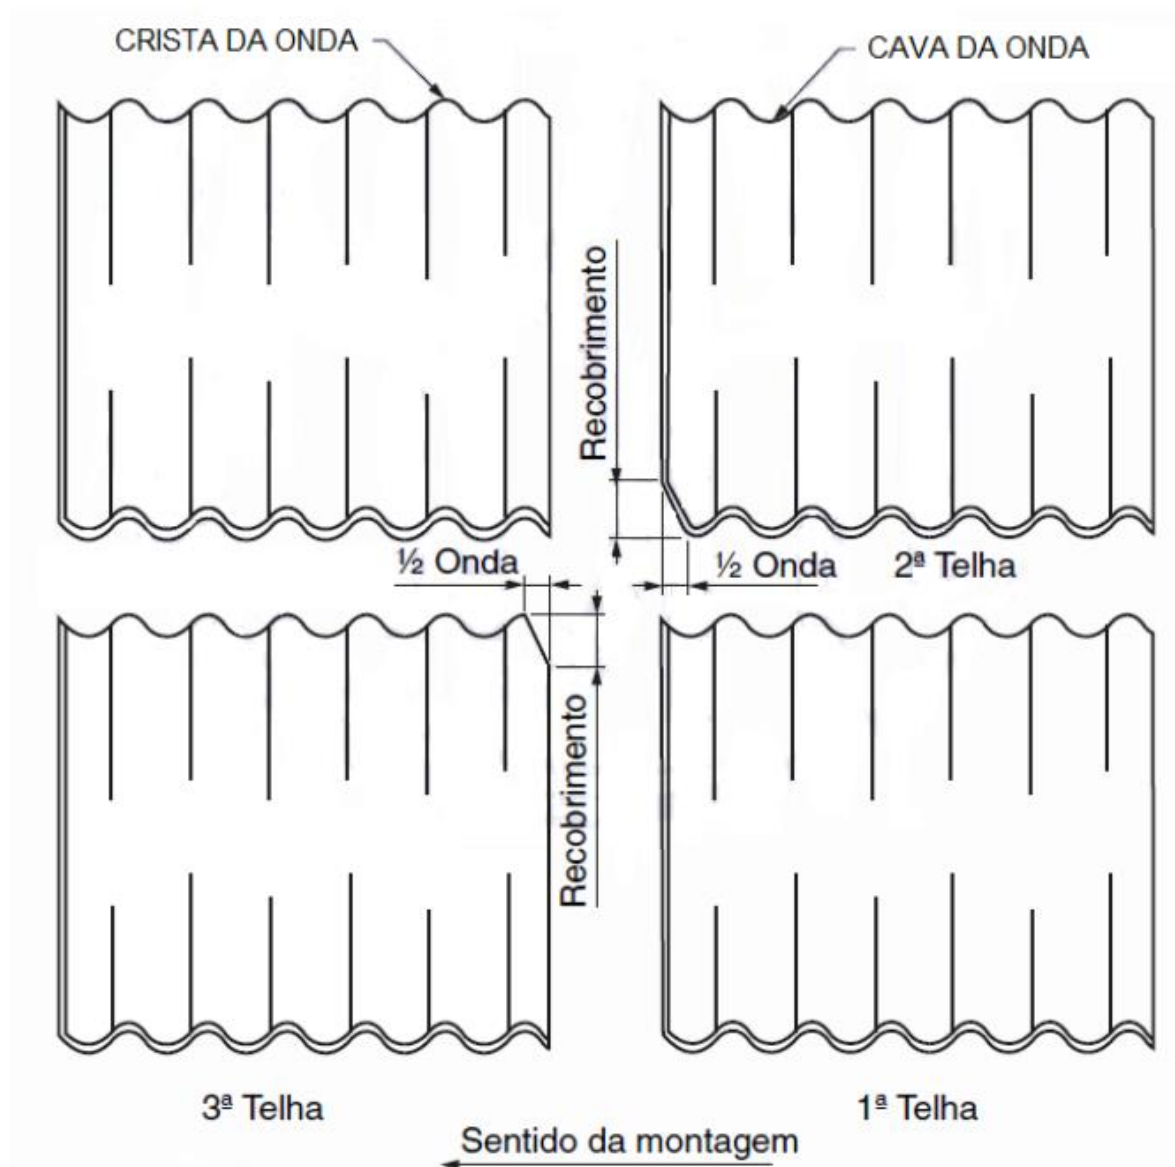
Esquema de execução do corte de canto das telhas Fonte: Adaptado ABNT 2014
